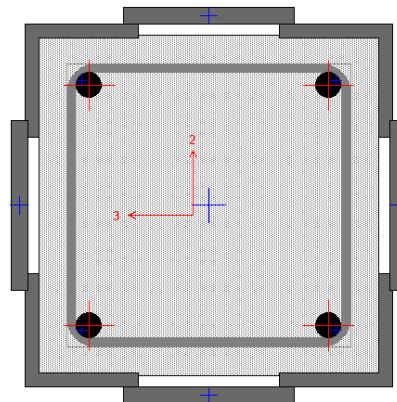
9 Configuración del reforzamiento para la columna C1 – Piso 1
